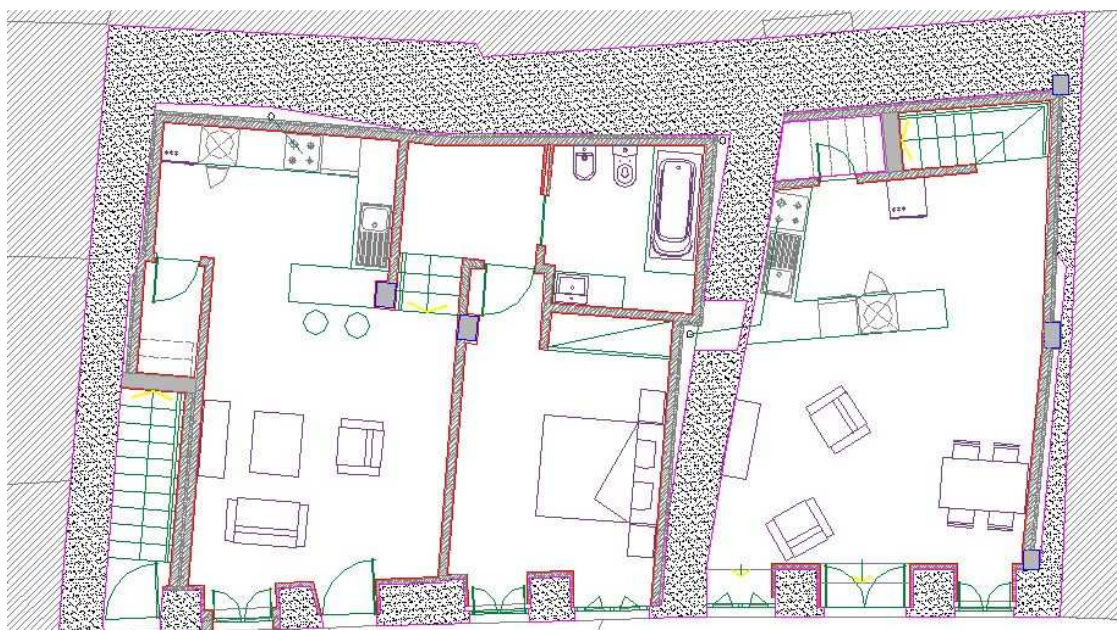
Planta do piso 0 do conjunto de edifícios em estudo
